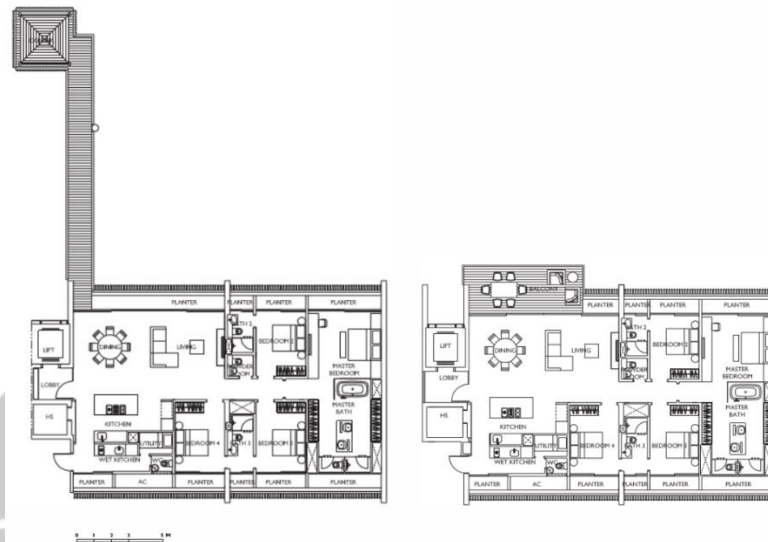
3 Bedrooms Floor Plan Goodwood Residence
